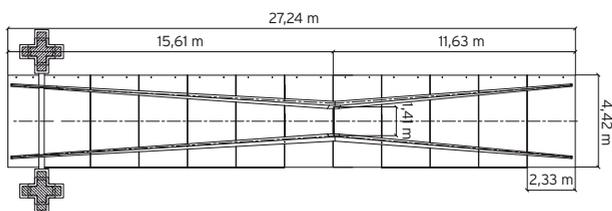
Konstruktion - Grundriss Canopy
